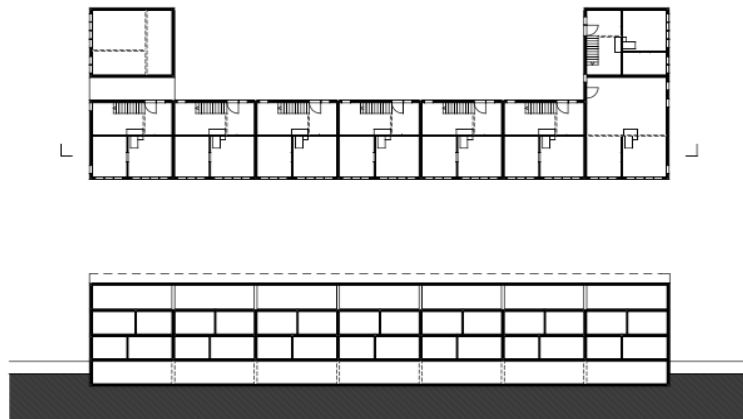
Grundriss und Schnitt des Langhauses, Annahme 1:500
